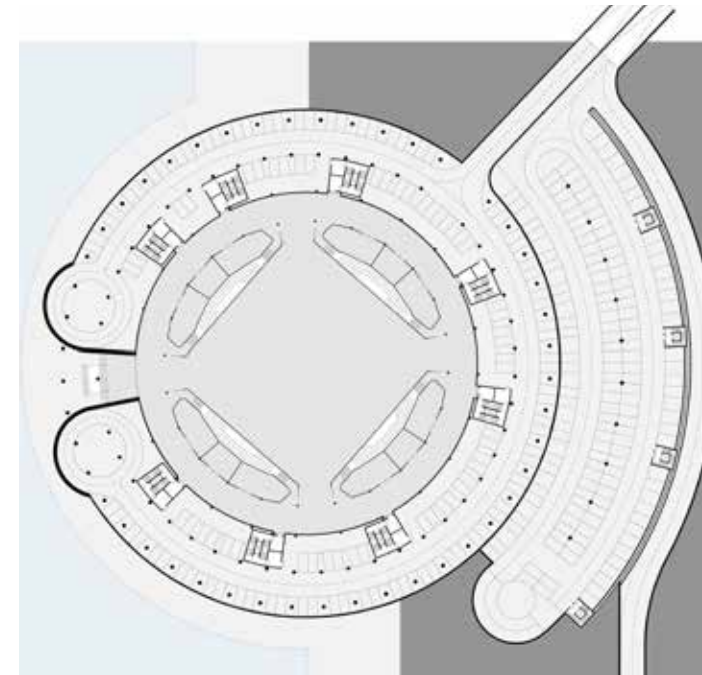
Pianta a quota +1 m e +5 m del Padiglione S
